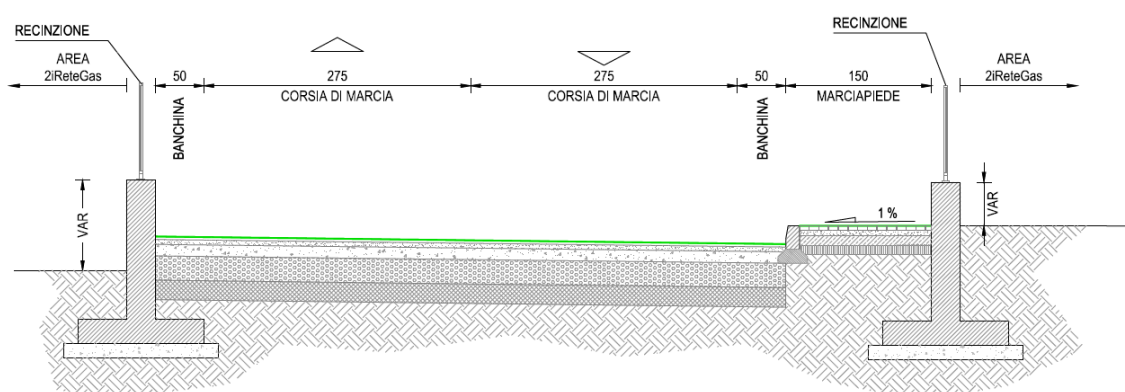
Sezione Tipo nuova viabilità accesso privati
